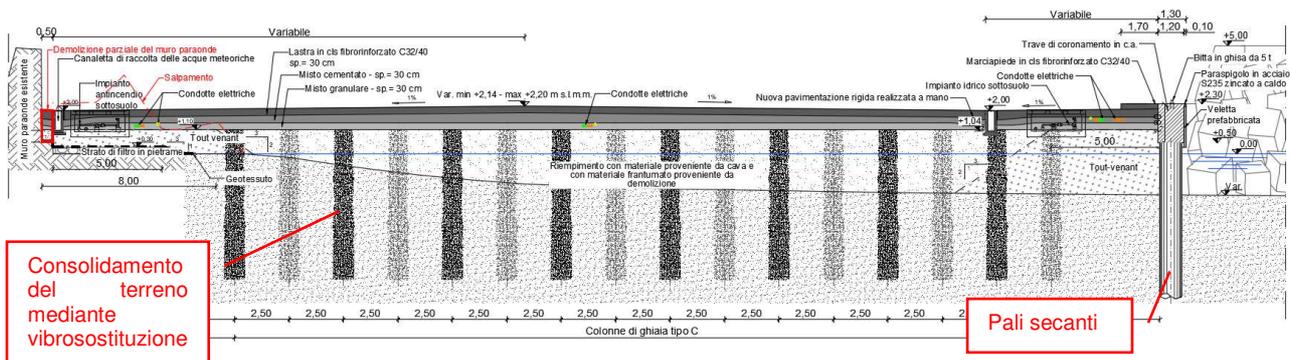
Progetto Esecutivo: Sezione tipo a2-a2 da prog. 134,80 a prog. 254,80 m
